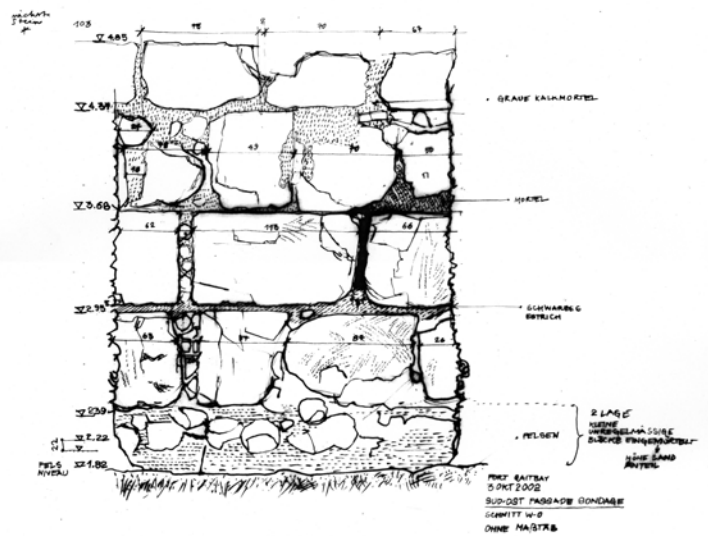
Aufriss der Mauerfundamente unter dem östlichen Abschnitt der Südfassade.
